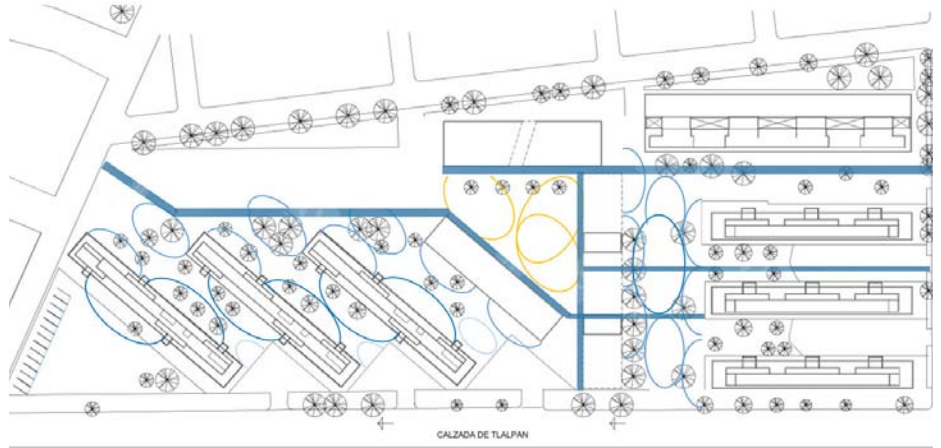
Recorridos lineales de conexión. Elaboración propia
